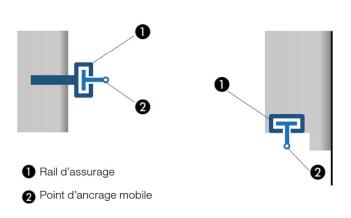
Classe D - Exemple de dispositifs d'ancrage équipés de rails d'assurage horizontaux
